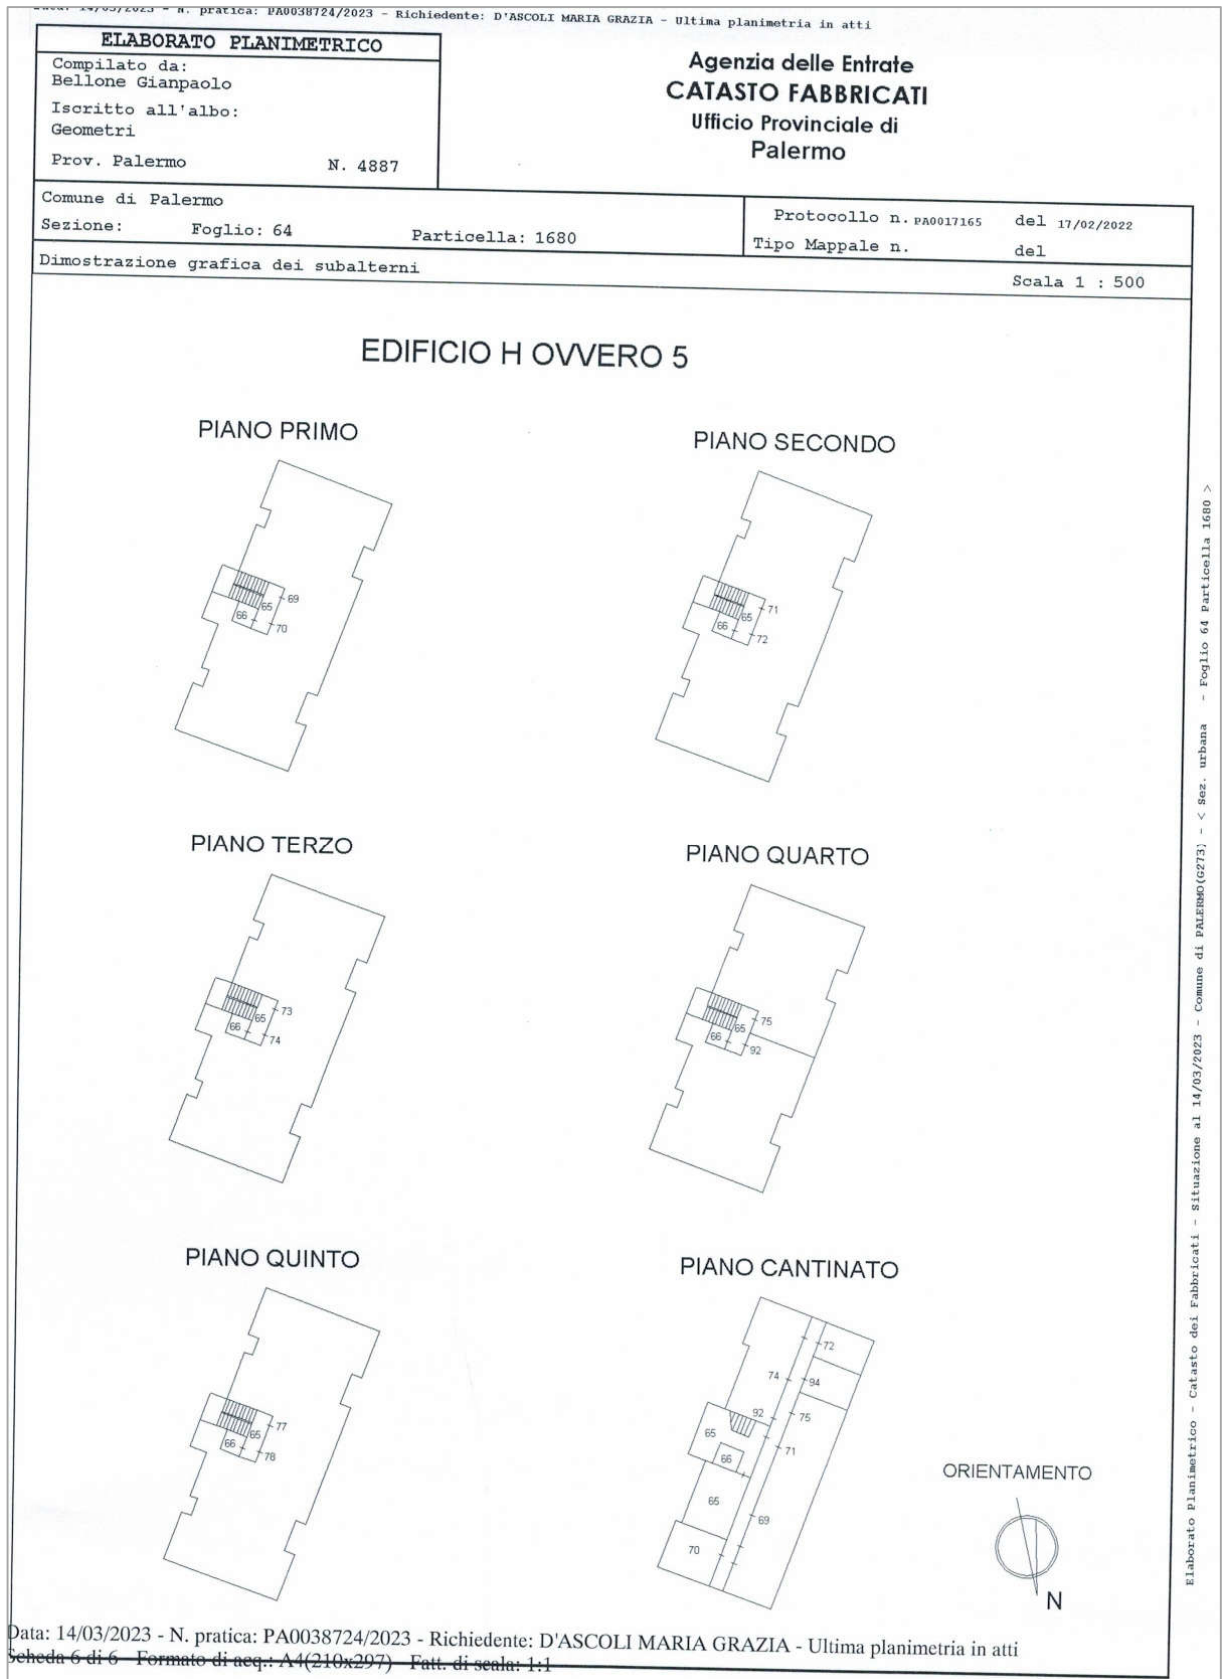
Elaborato planimetrico catastale “Edificio H” della p.lla 1680
